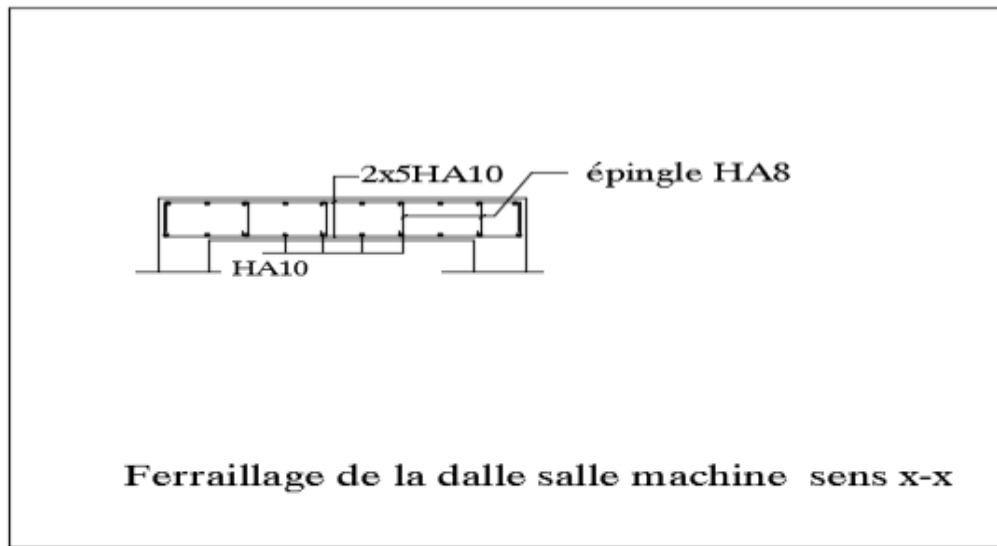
Plan de ferrailage de la dalle pleine salle machine
